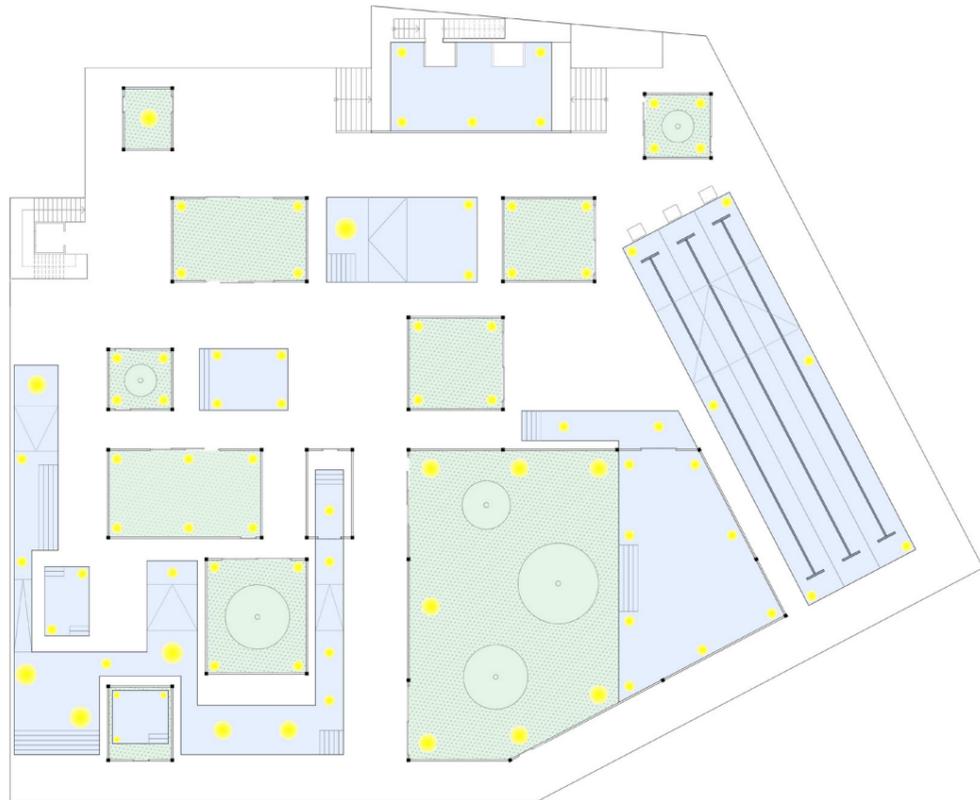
Grundriss Badehalle - Beleuchtung Wasserbecken und Atrien
